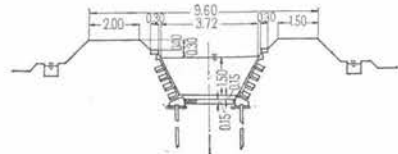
邑楽用水路 (合口左岸連絡水路) 標準断面図
